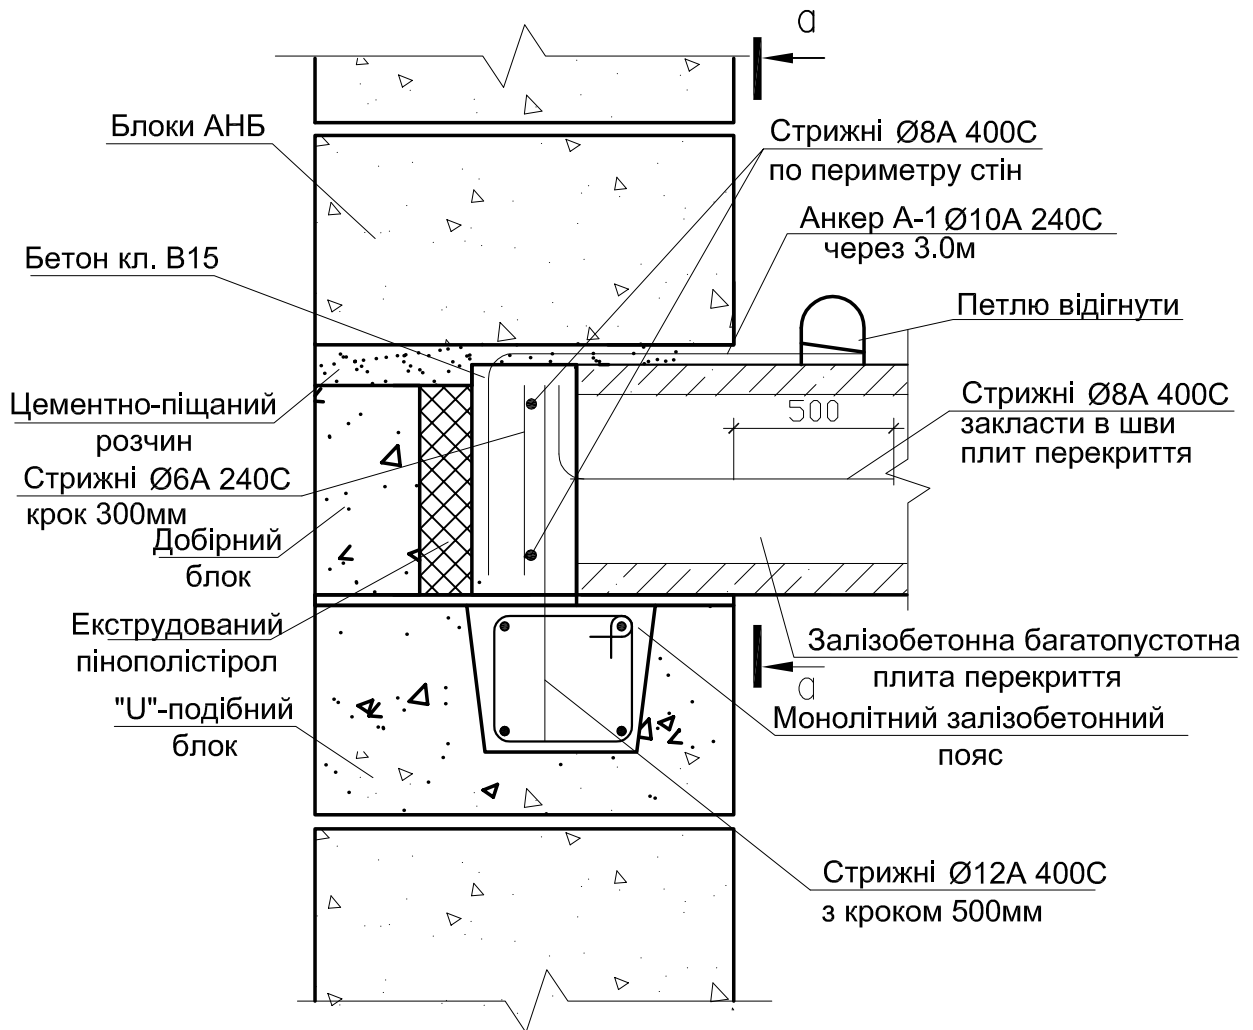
Спирання збірної залізобетонної плити на перемичок або поясу на основі U-блоку
